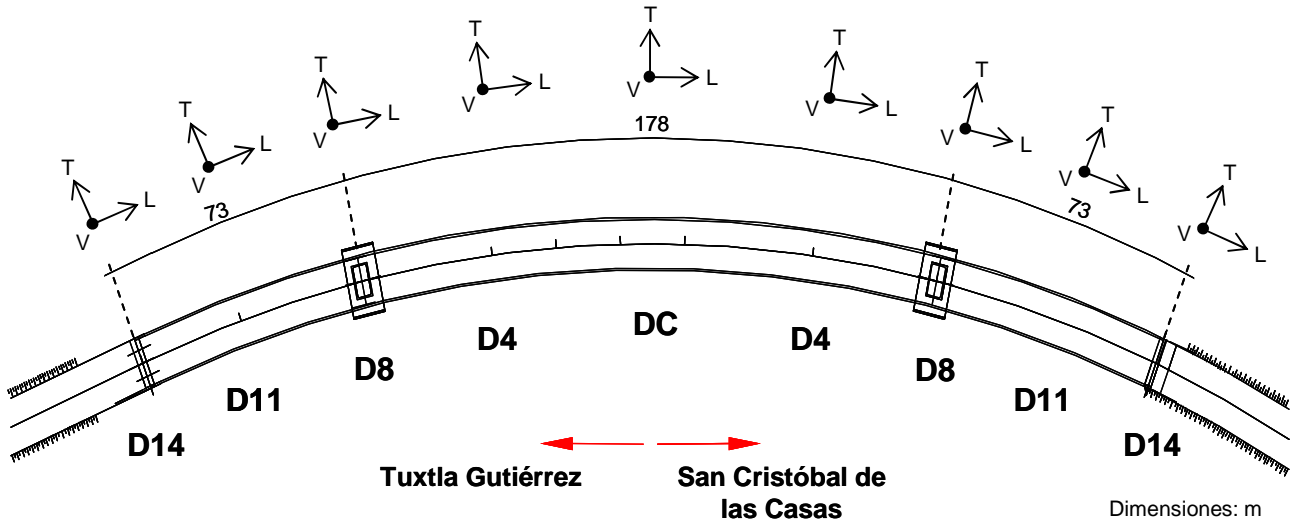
Ubicación de las dovelas instrumentadas del puente San Cristóbal (vista en planta) Dimensiones: m
